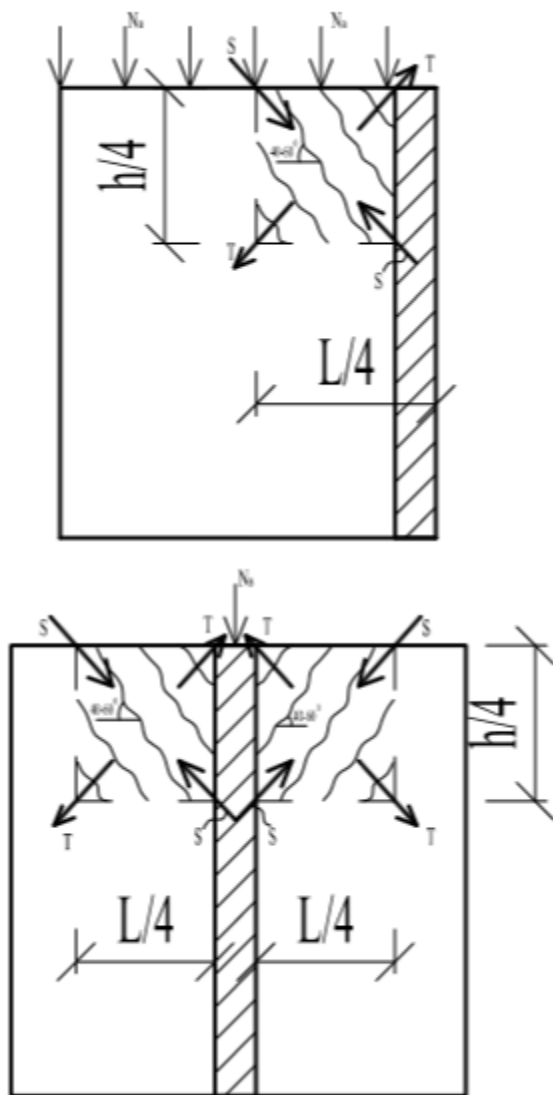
Схема образования трещин и общий вид разрушения стыка разнодеформируемых стен при передаче нагрузки на внутреннюю стену
